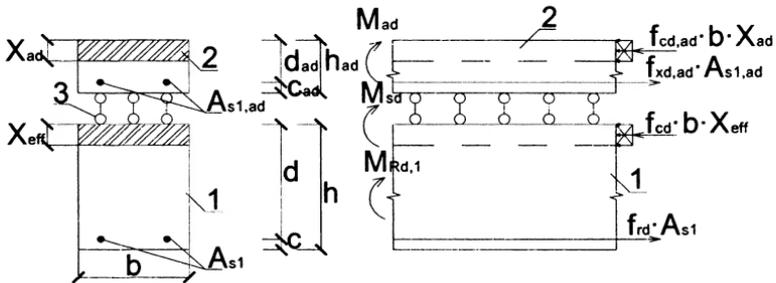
Расчетная схема усиления наращиванием без сцепления существующего и нового бетона
